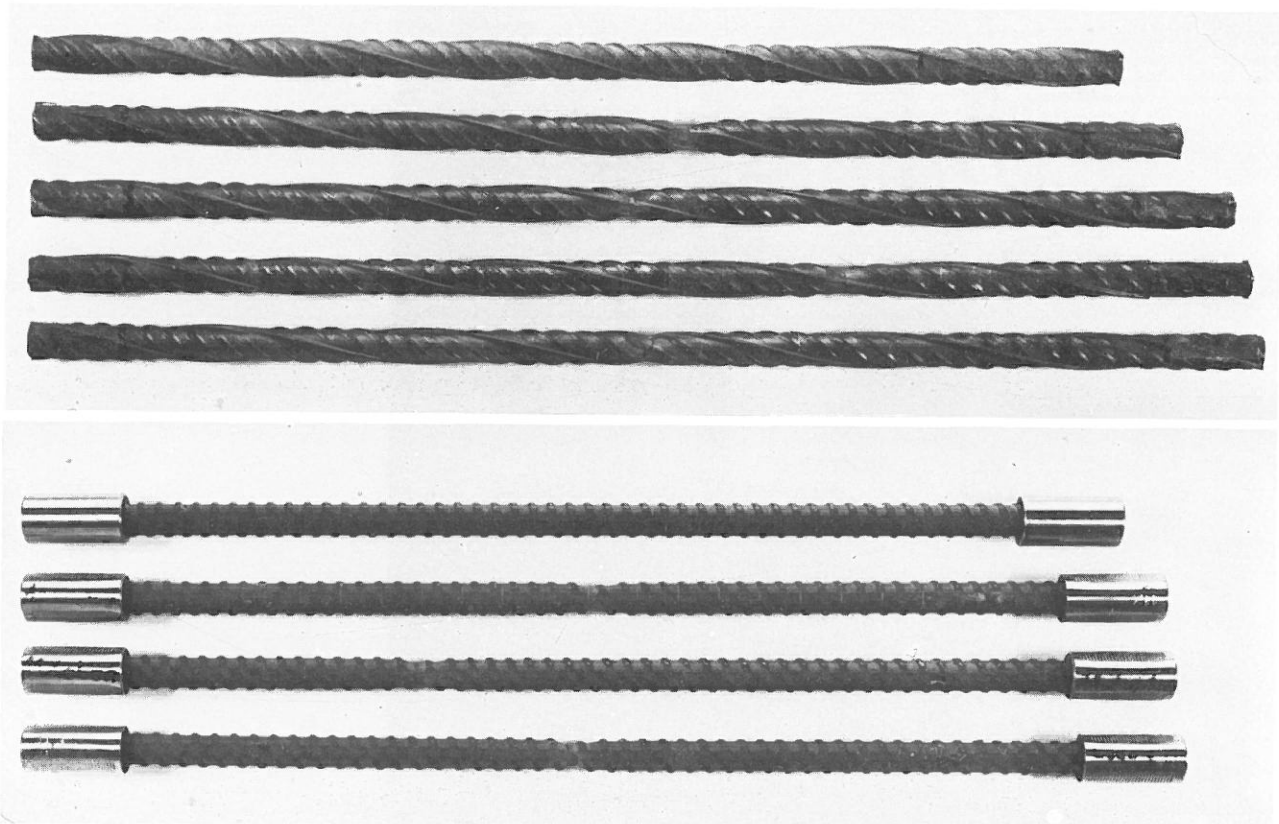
Betonstahl-Proben aus BSt 420/500 RK (Rippentorstahl) und BSt 1100 (hochfester Betonstahl).
